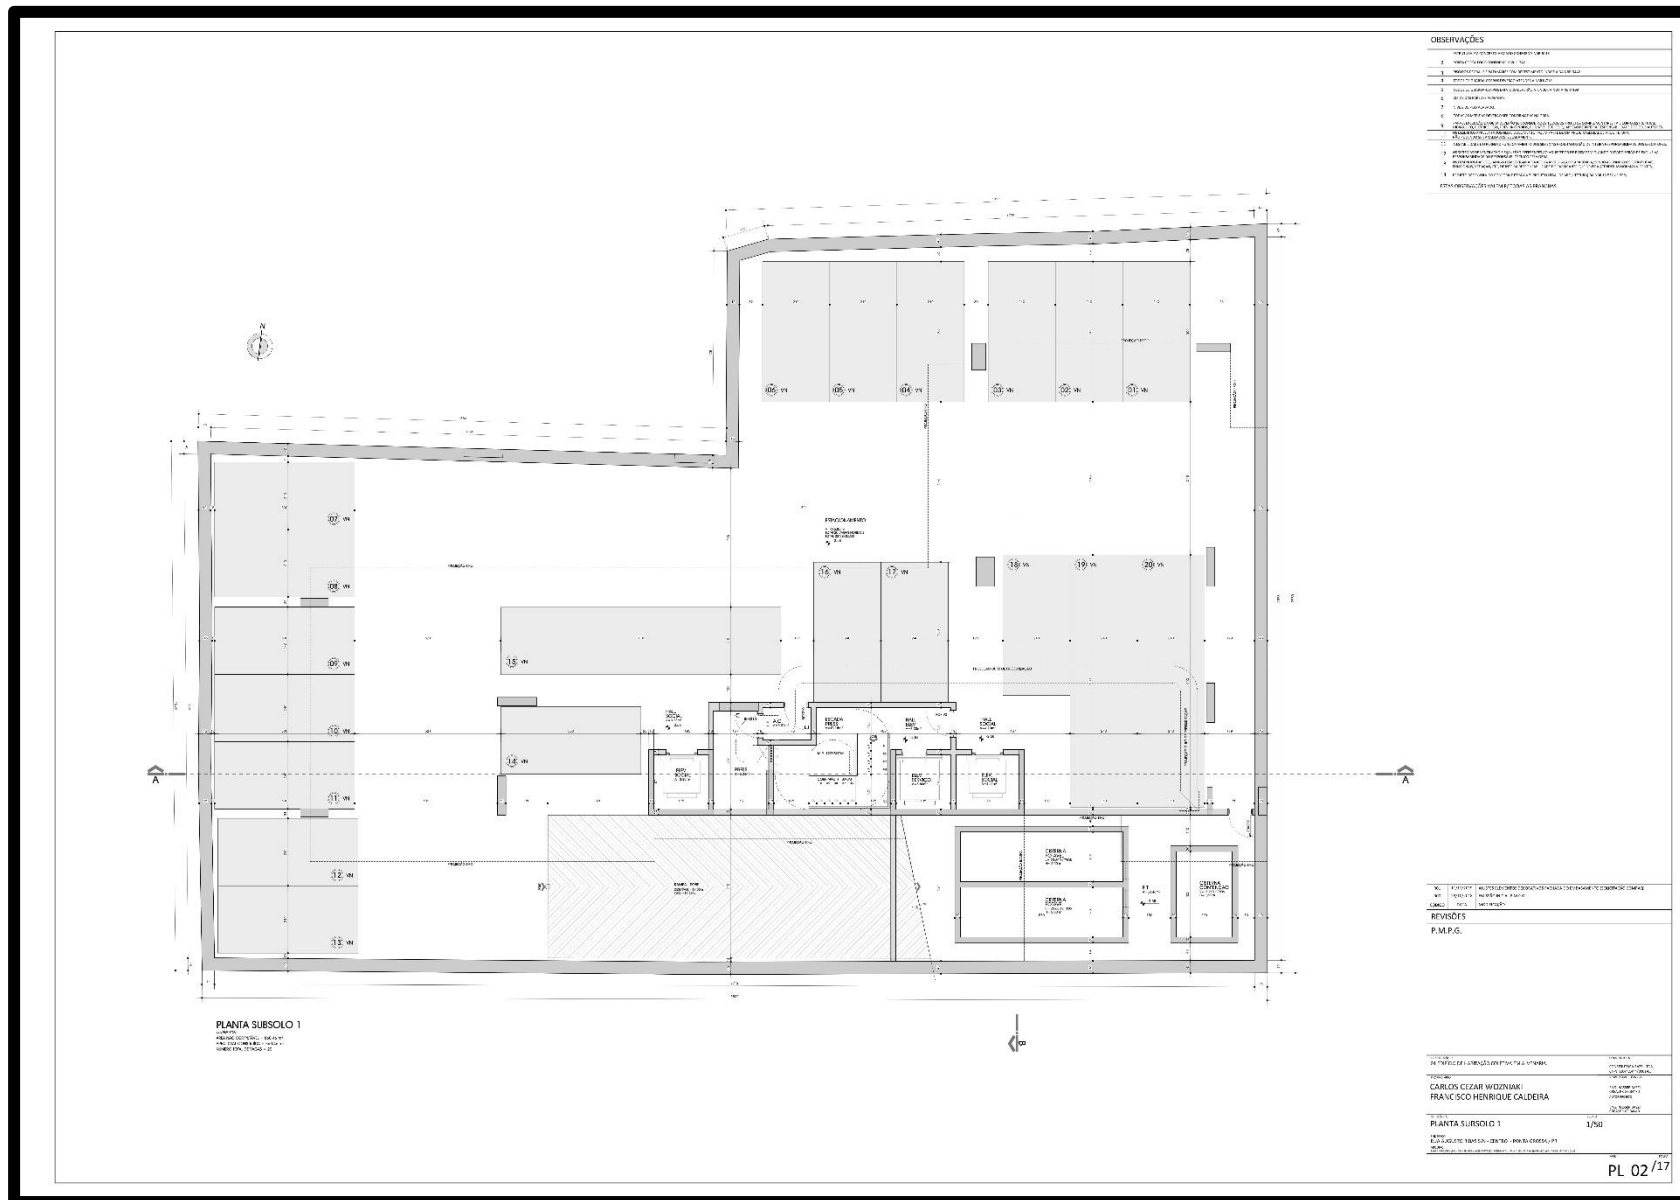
Planta pavimento subsolo. Fonte Construtora Bazzi (2020).
